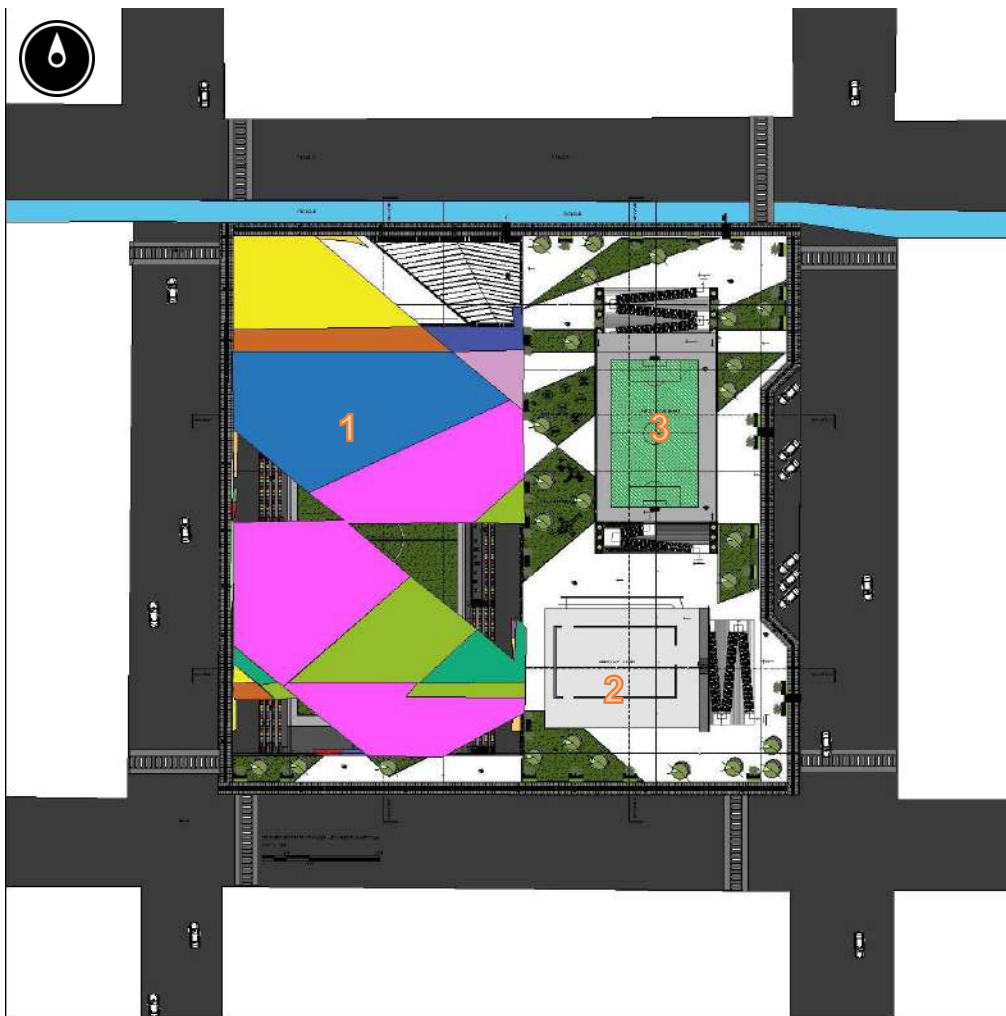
Planta general del proyecto con cubiertas. Fuente: Elaboración propia 2021.
